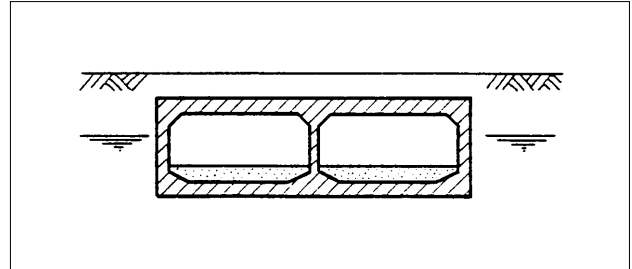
Tunnels construits à ciel ouvert et destinés au trafic routier et ferroviaire:
